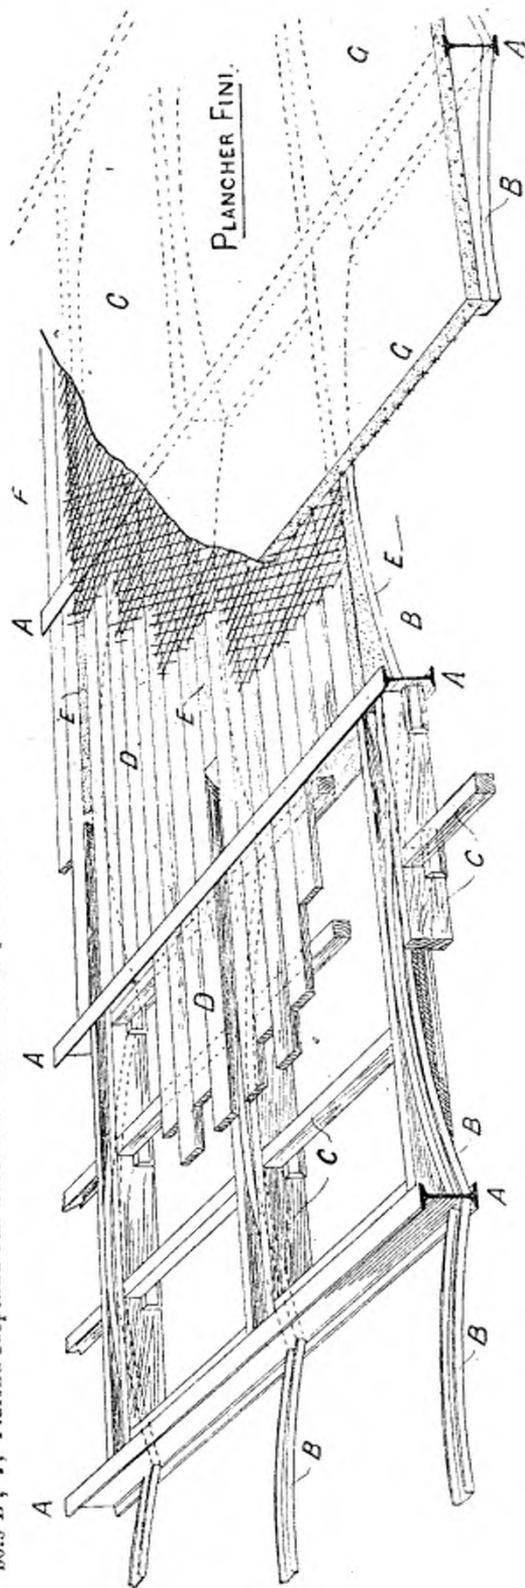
Plancher plat avec renforts ; voûtes en béton sur fers en U (Système Golding).
